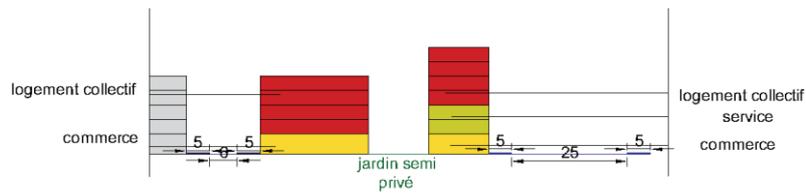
coupe des fonctions sur voie statut1. Fait par l'auteur
